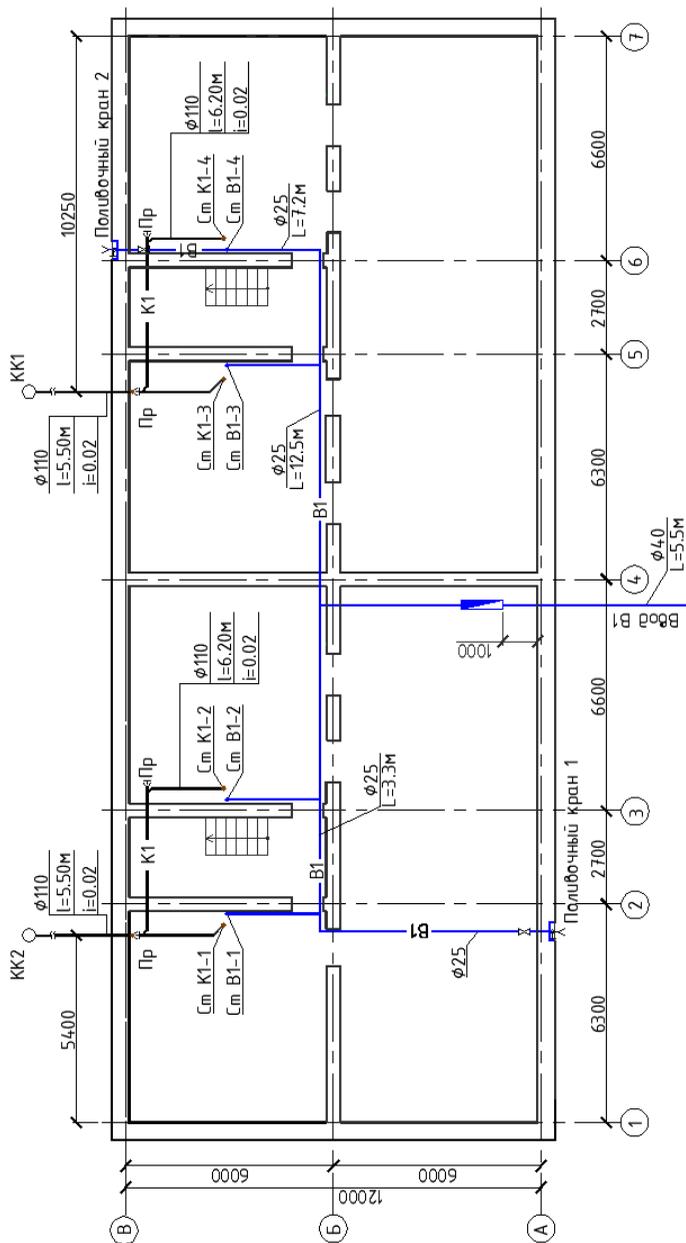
План подвала с внутренними сетями водопровода и канализации
